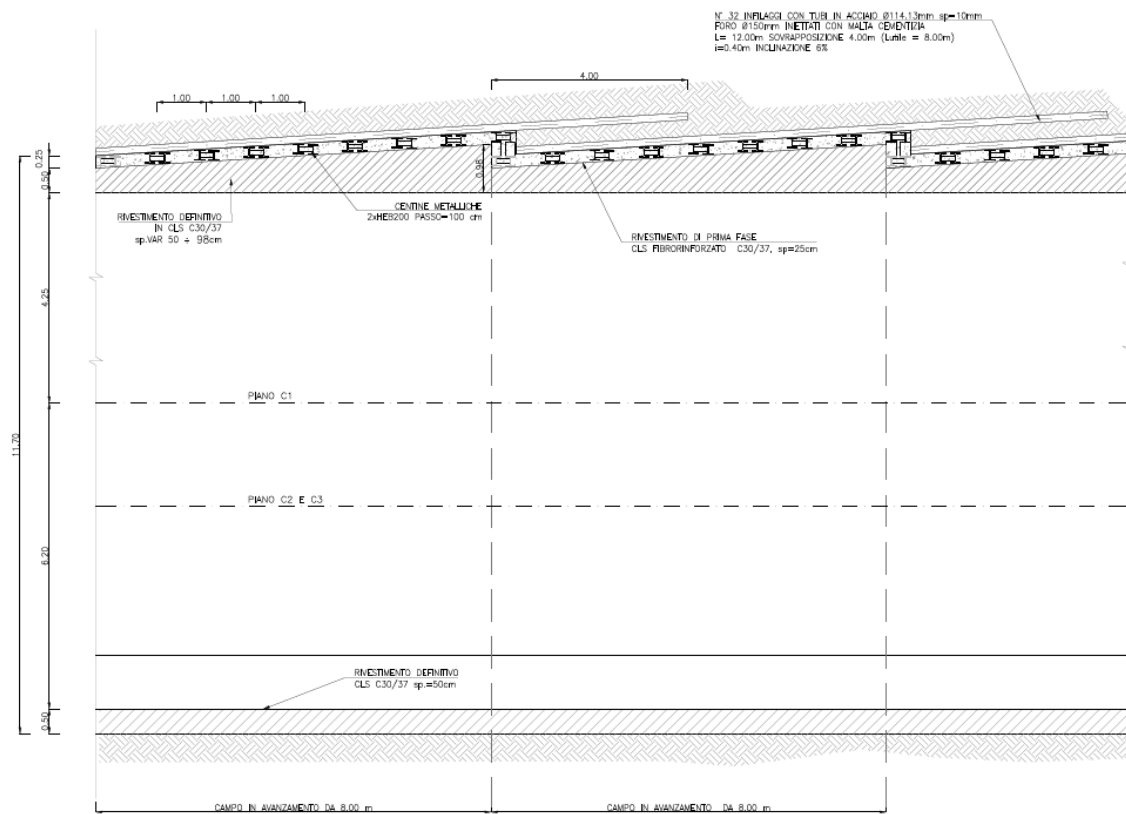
Sezione tipo SGC-Imb: geometria del cavo e interventi di sostegno, sezione longitudinale
